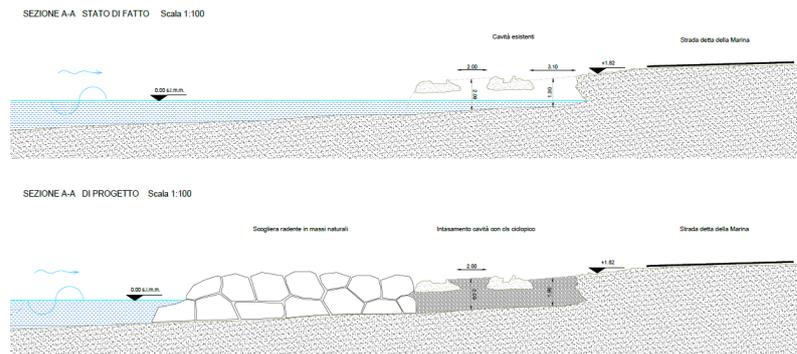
Elab. A-I-10-5 Area intervento 10 – Intasamento cavità
